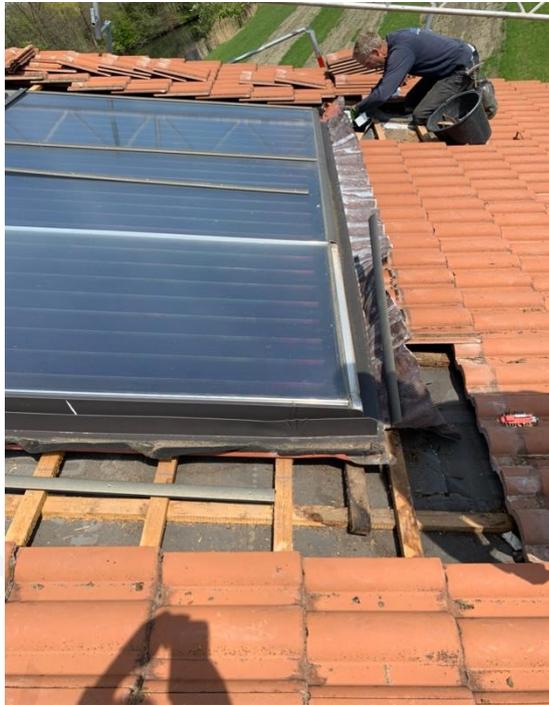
Bauteilöffnung zur Findung der Schadenursache
